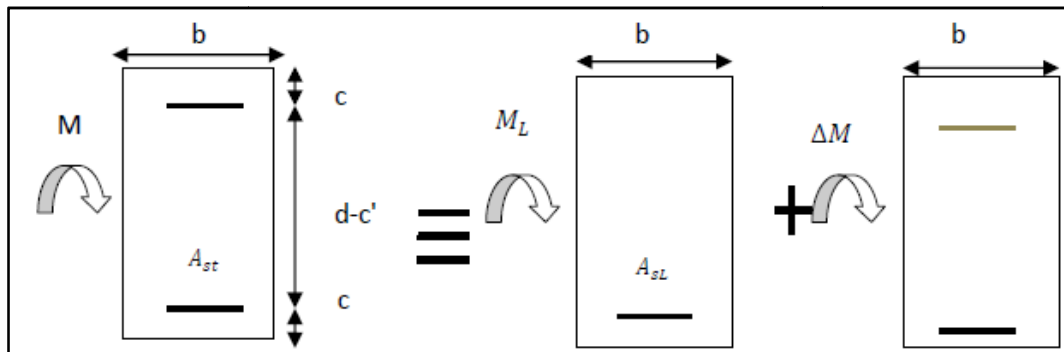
Schéma de Ferraillage des poutres doublement armée
